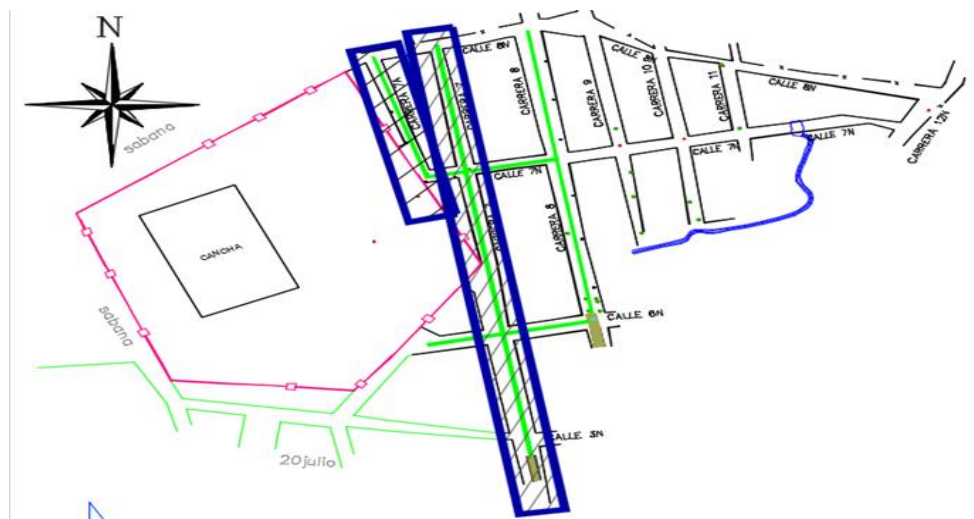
Planta general de pavimentación fuente: unión temporal coyupe 2017.
